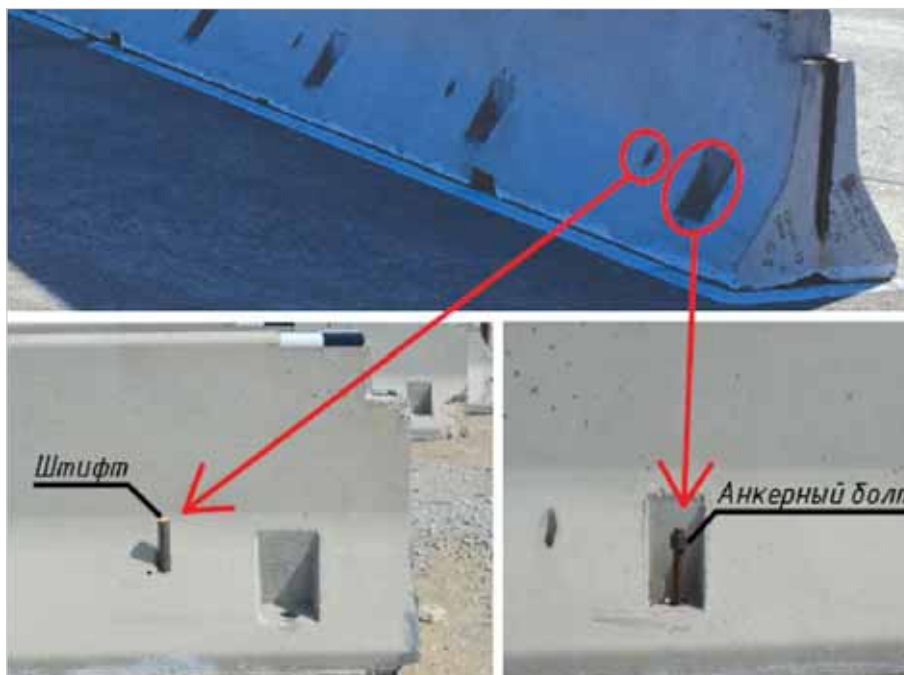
Вариант универсальной конструкции парапетного ограждения
